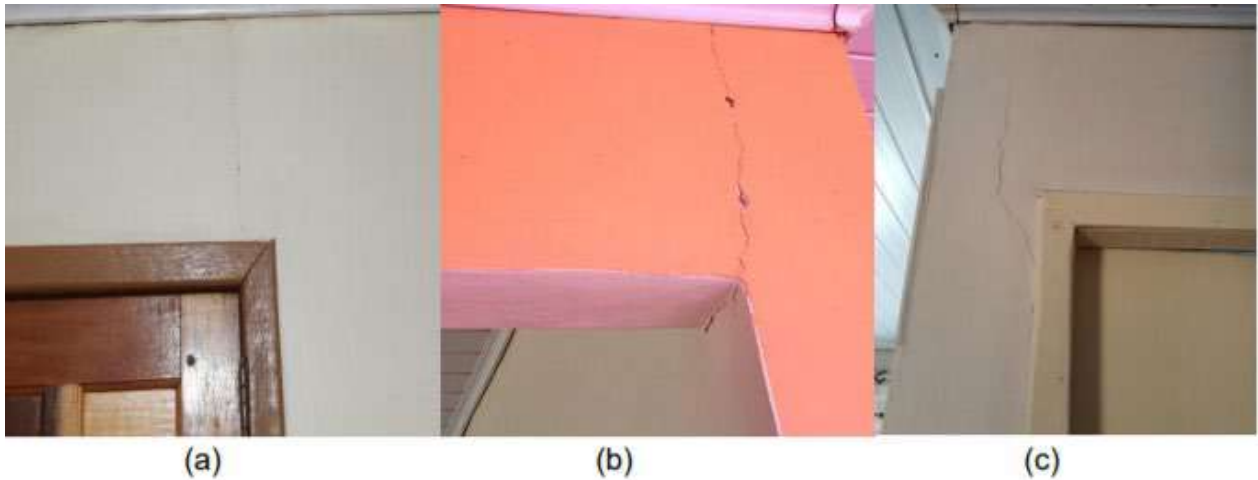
Fissuração em parede de alvenaria na região dos pontos de fixação de portas.
